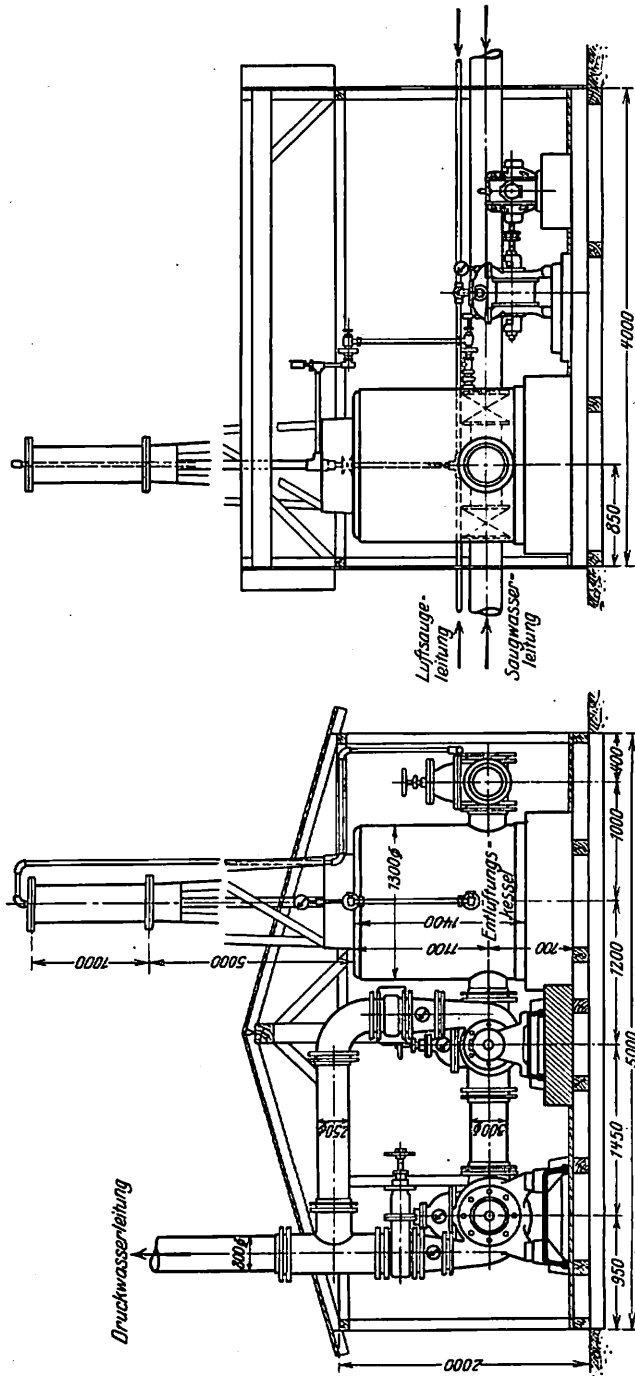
Entlüftungsanlage der Siemens-Bauunion.
